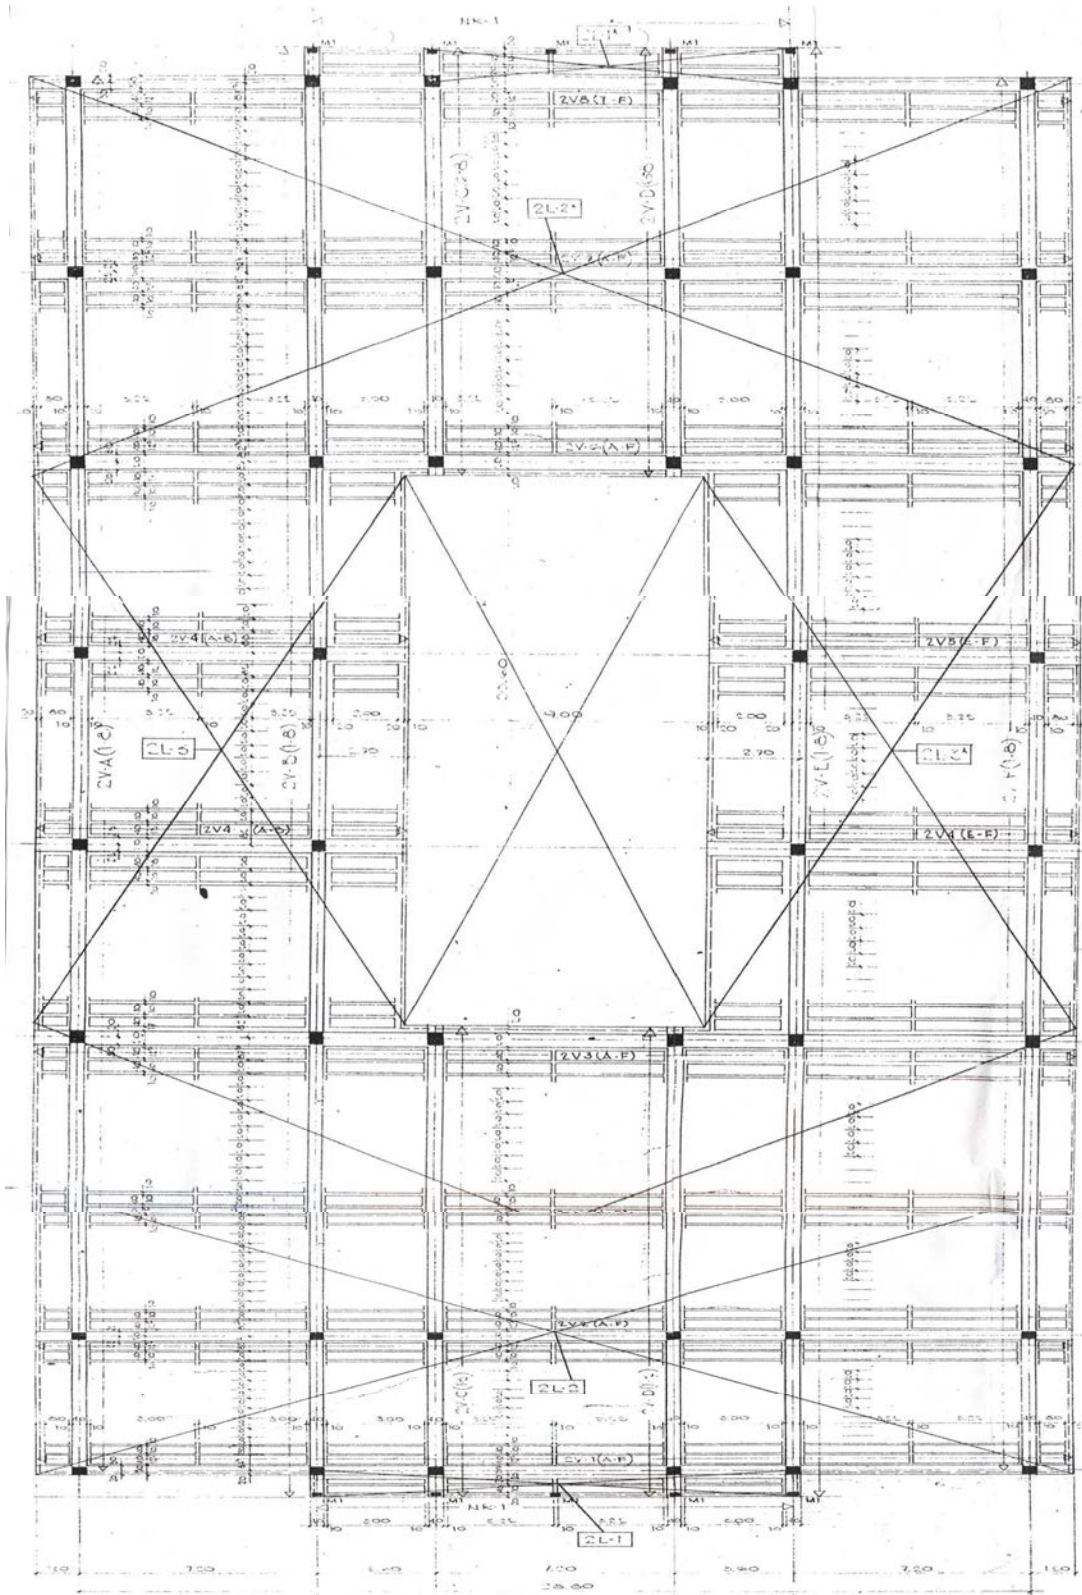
Detalles de losas. Tipo Cajetón
